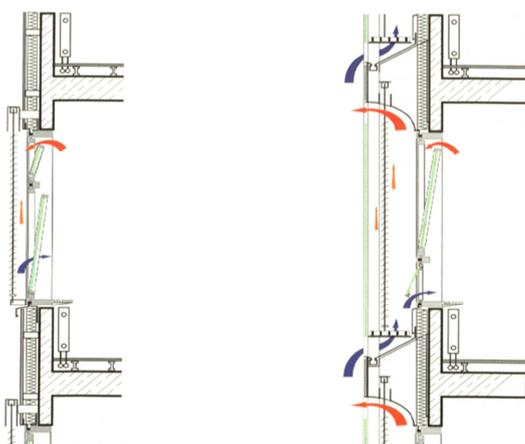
Vergleich einer einschaligen Fassade (links) mit einer Doppelfassade (rechts)<sup>51</sup>
